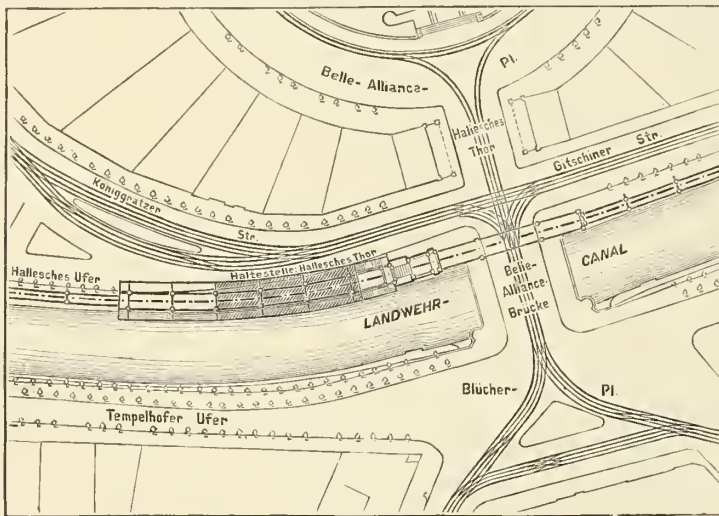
Lageplan der Haltestelle „Hallesches Thor“.
